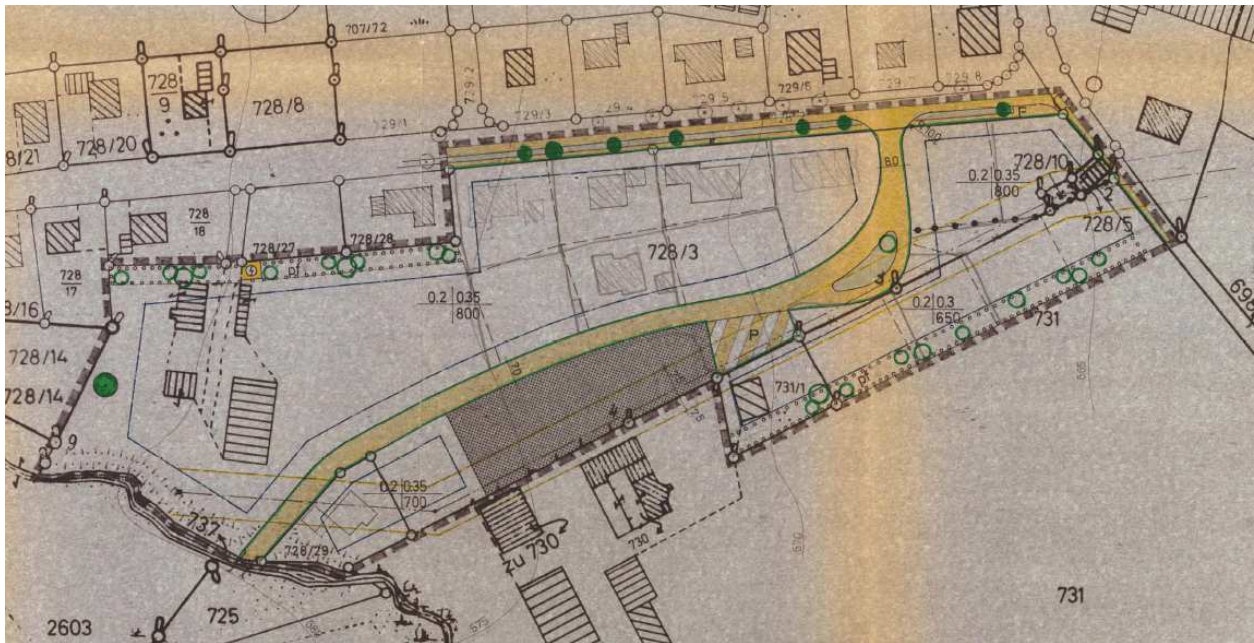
Ur- Plan des Bebauungsplans „Hansltrad“, Stand 17.10.1984
